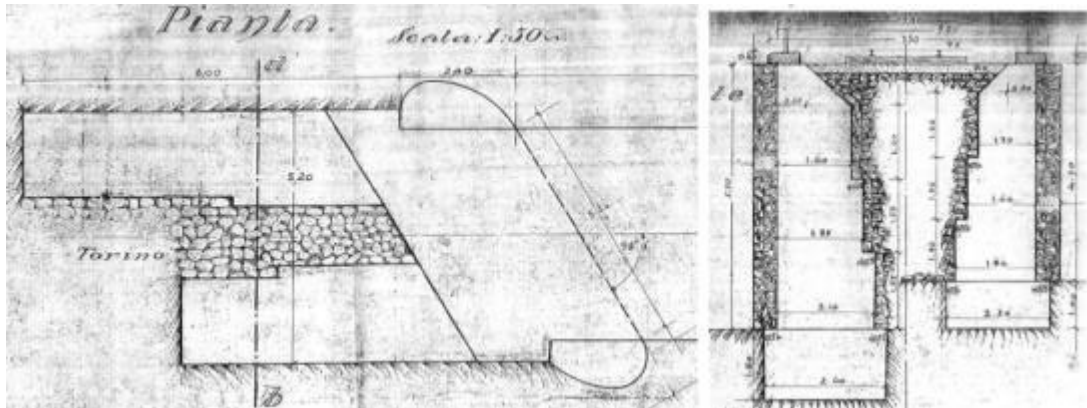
Pianta di spalla e sezione del muro d'accompagnamento - ponte Chesola, linea Torino-Pinerolo, progr. 10+898 (Archivio FS- TO).
